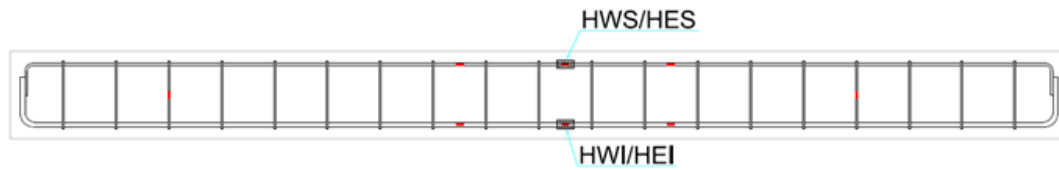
Disposición de las galgas de hormigón en la sección central de la viga. Fase Vigas I
